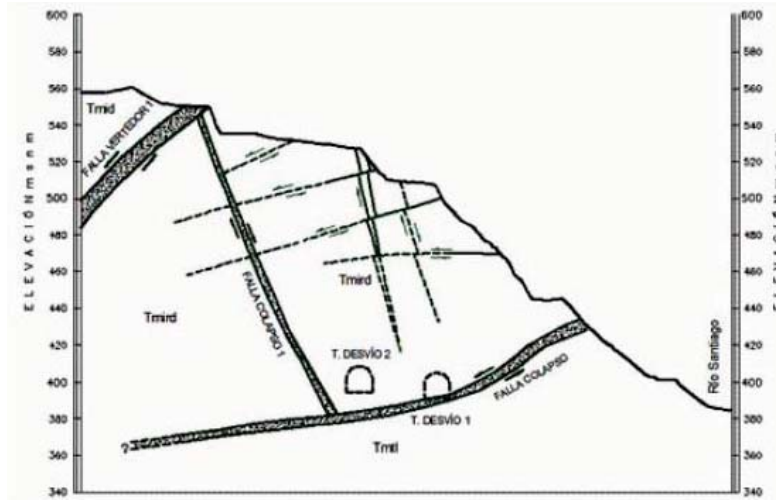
9 Sección esquemática del bloque inestable, limitado por las fallas Colapso y Colapso 1.
